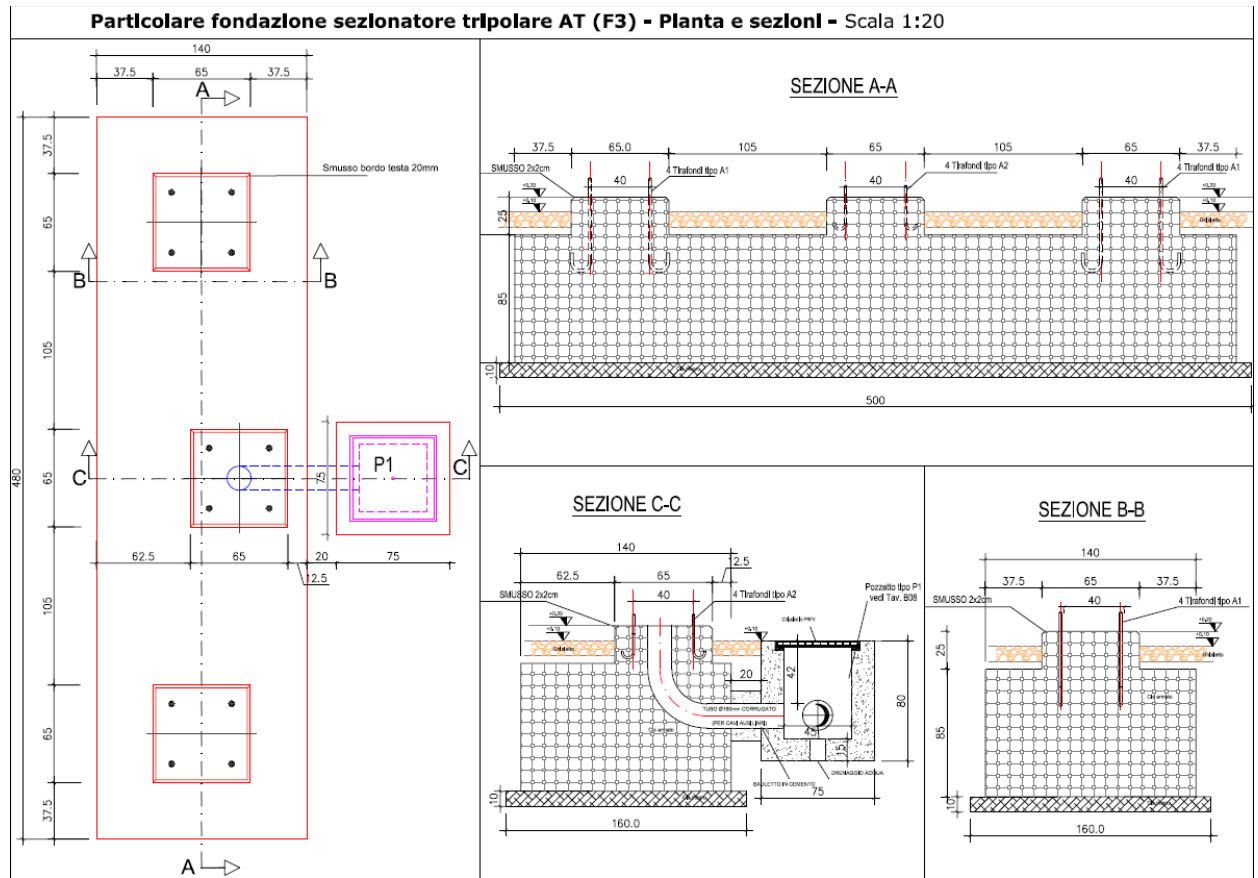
Particolari costruttivi Fondazione Sezionatore Tripolare
